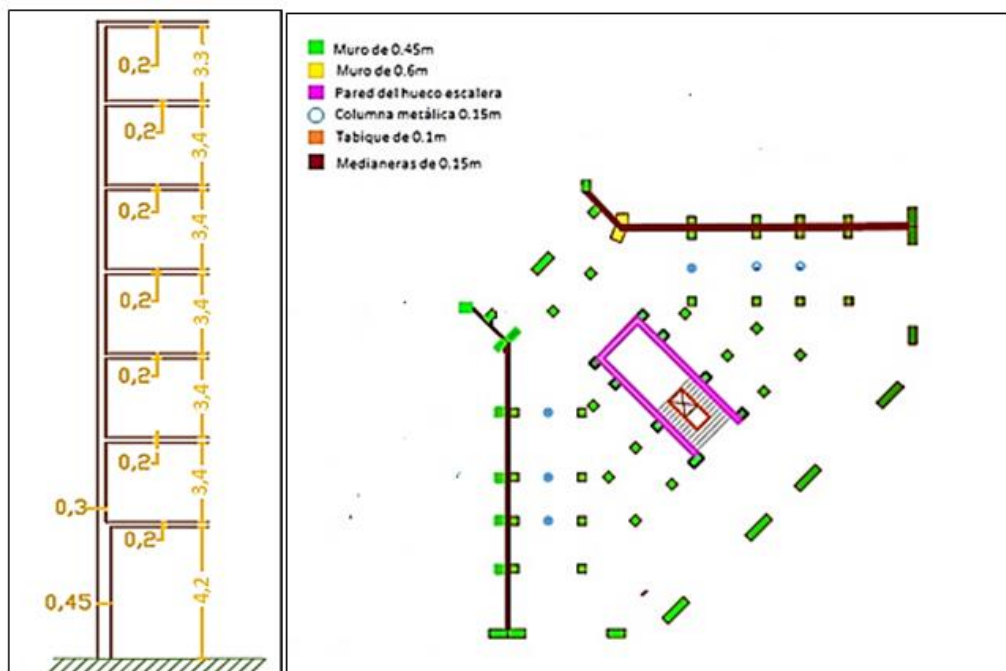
Planta baja del edificio (Fuente: Propia)
